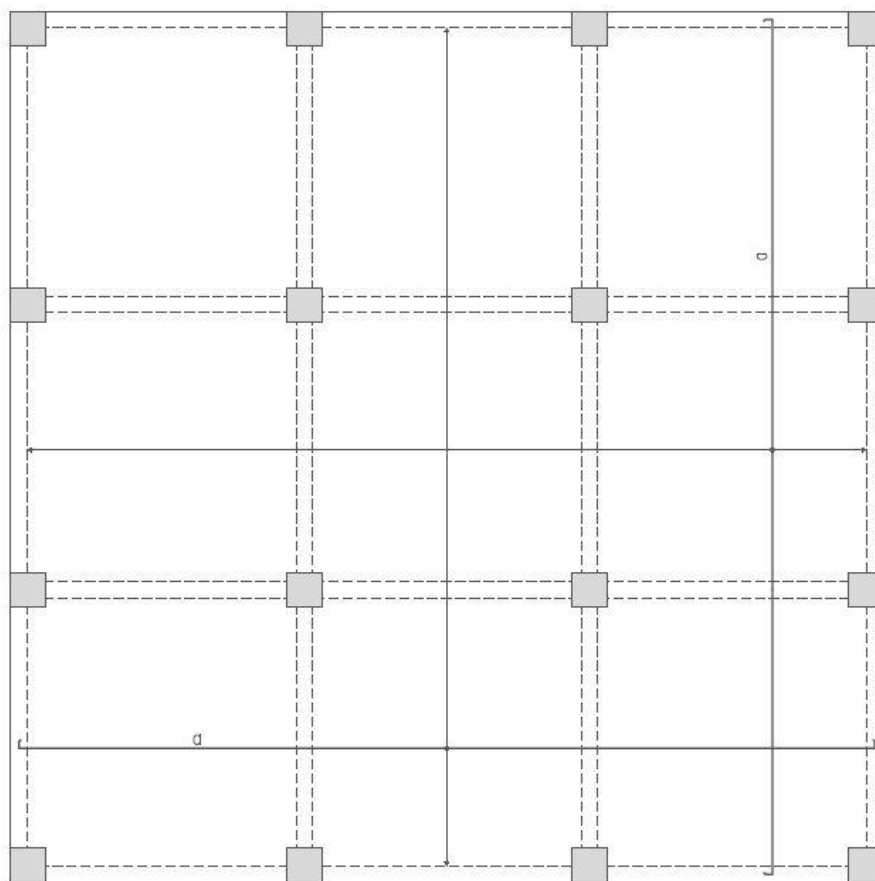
Pormenorização de laje de acordo com o EC2 para as armaduras inferiores
